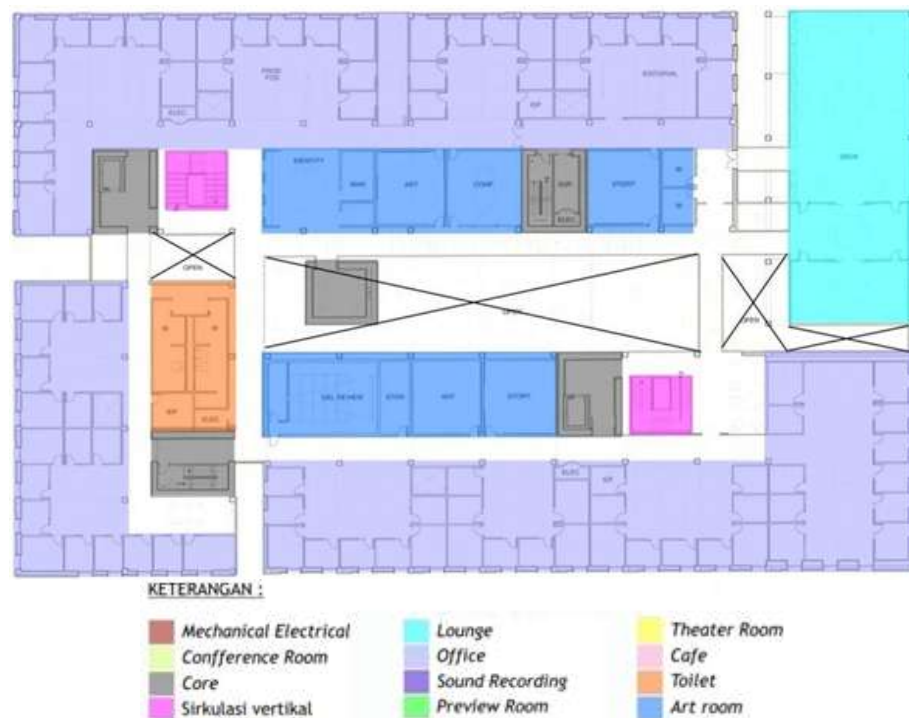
25 Detail Penzoningan Denah Lantai 1
